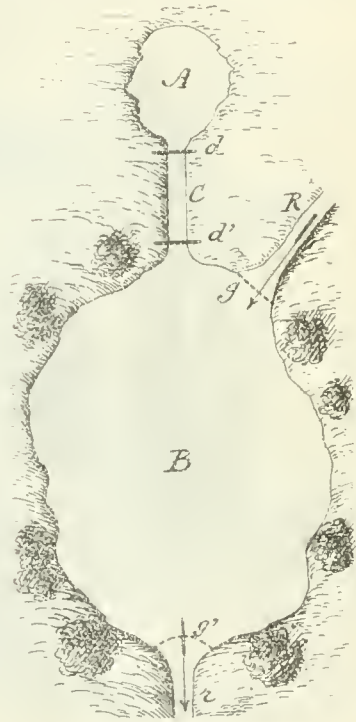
Plan d'un étang aménagé pour l'élevage des truites.
